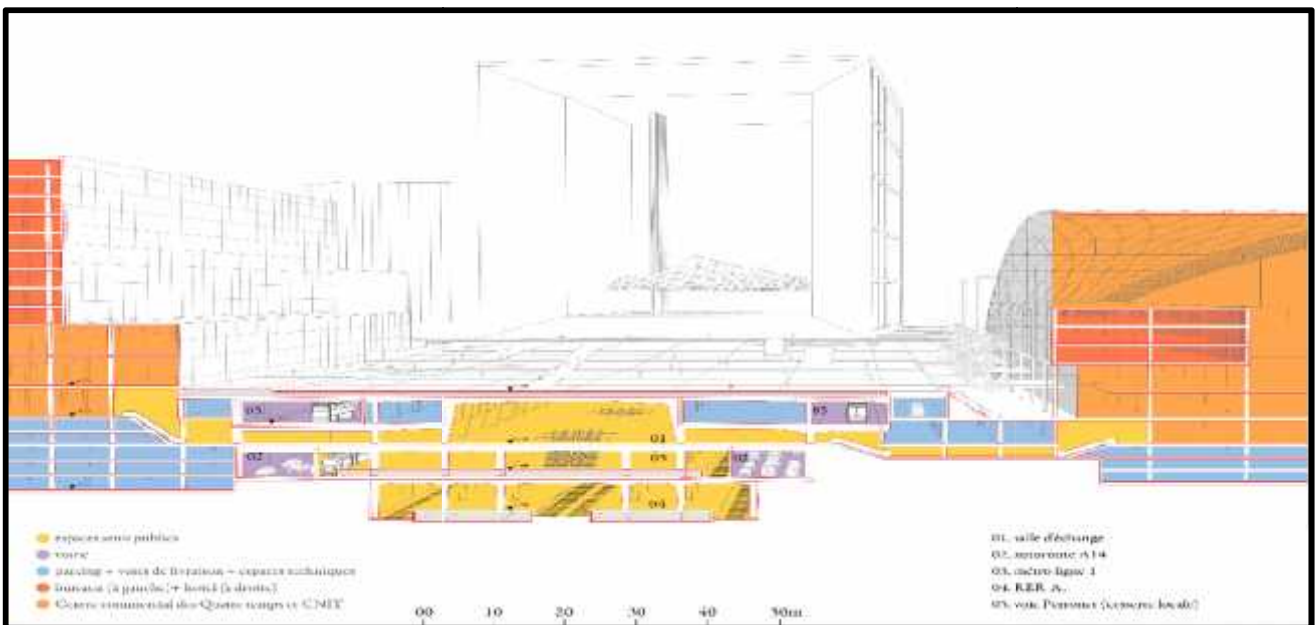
Coupe transversale de la dalle devant la Grande Arche,
